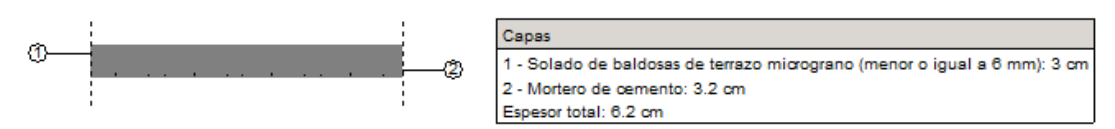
Detalle Pavimento Terrazo. Fuente: Programa CypeMEP
